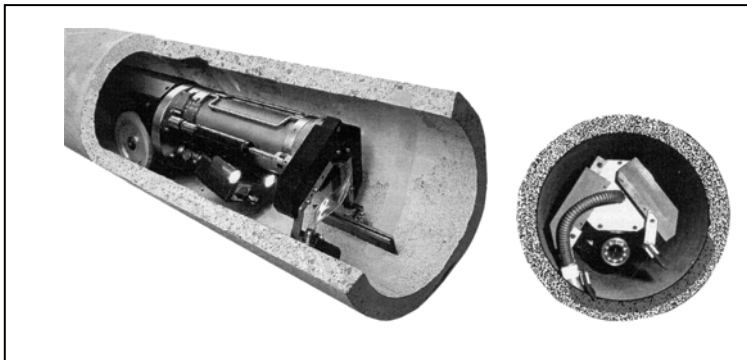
Spachtelarbeiten mit Kanalroboter [6]
